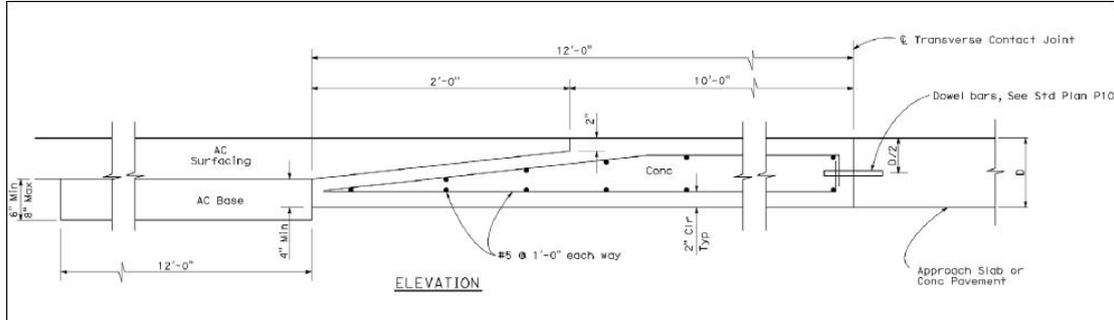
水泥混凝土與瀝青混凝土鋪面銜接之實驗性調整設計(示意圖)
